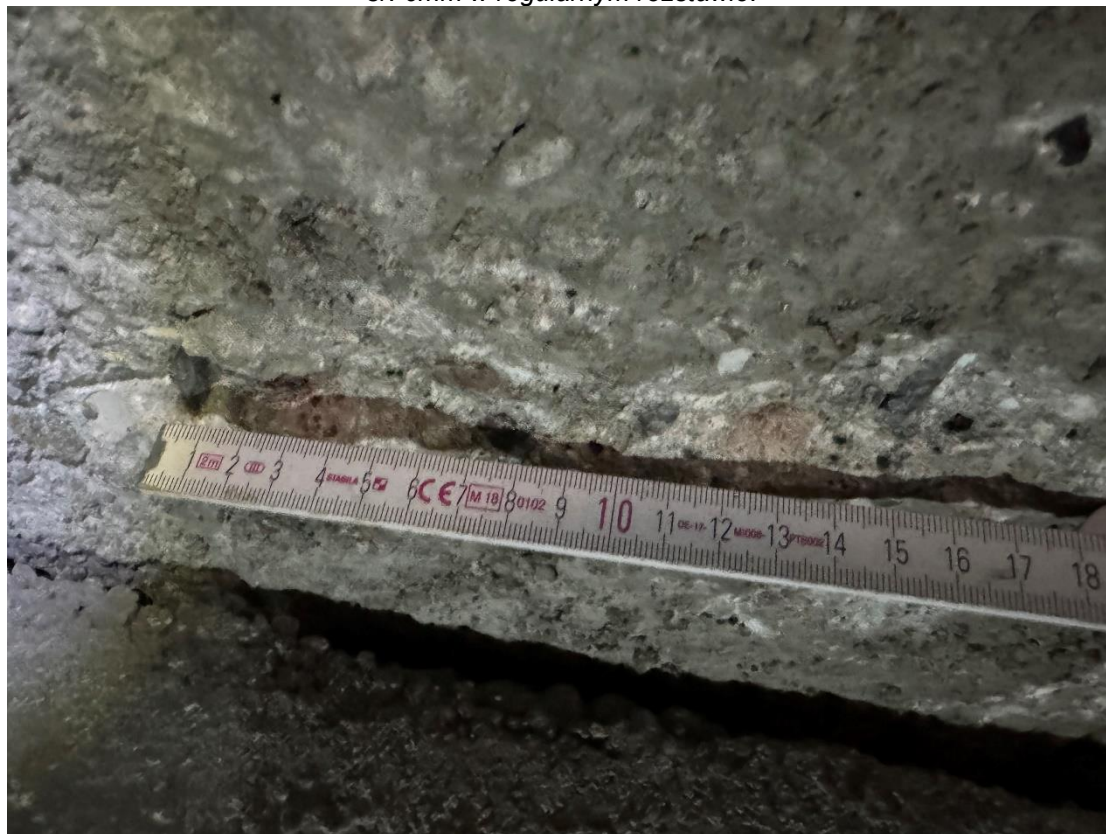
Zbliżenie na miejsce oparcia belek dachu bloku A.
